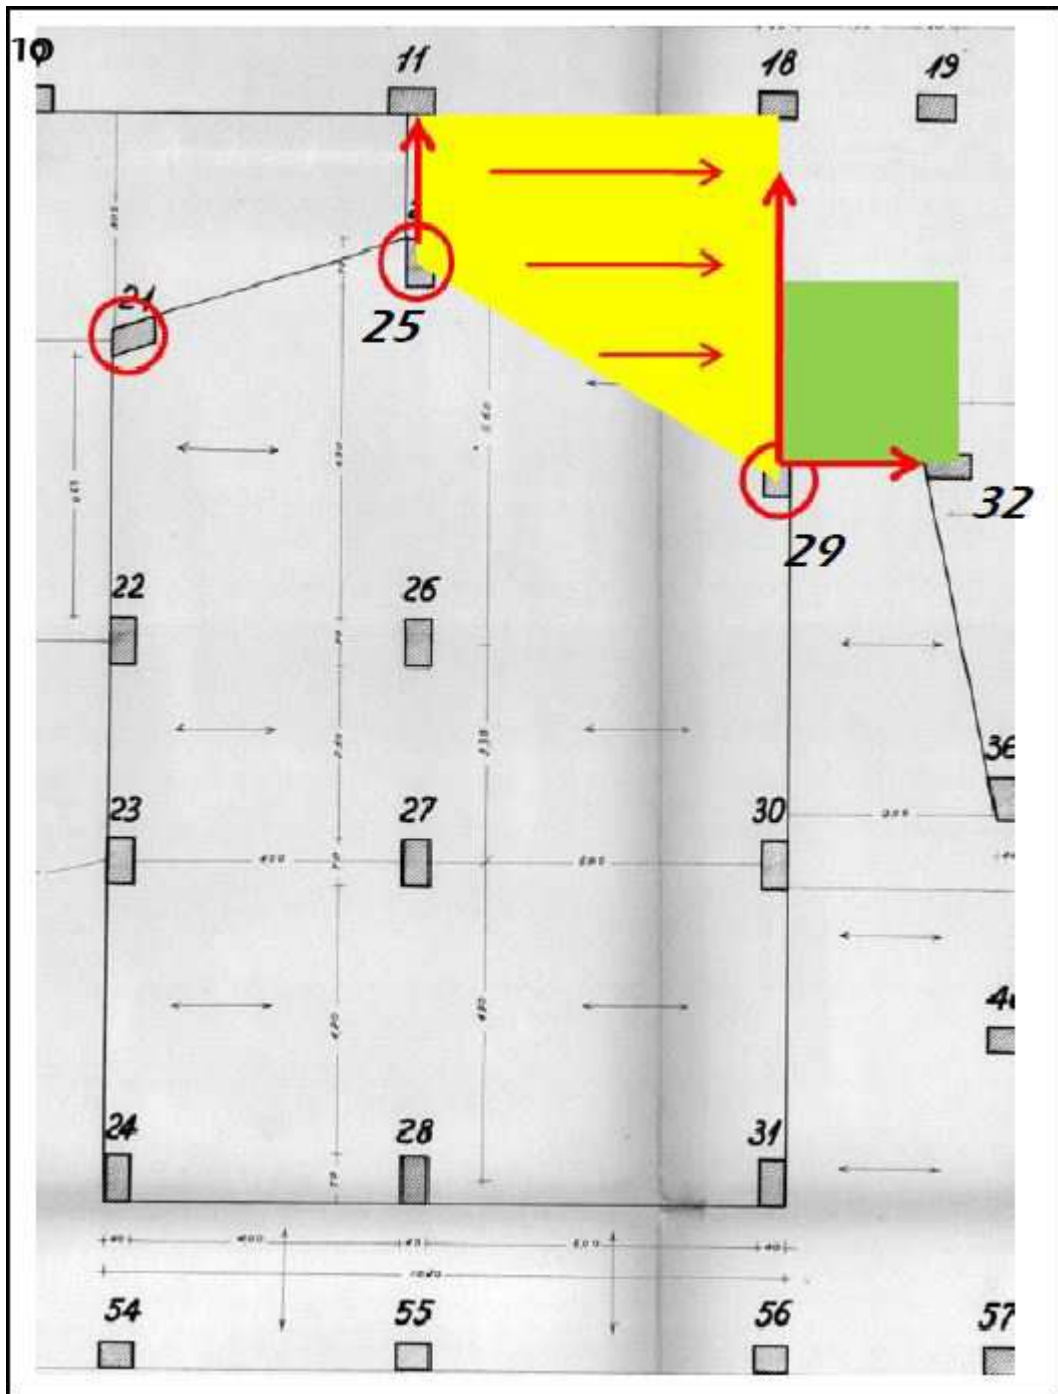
Effetti sulla pianta strutturale della Casa dello Studente. In giallo è indicata l'area fortemente interessata tra le travi 11-25 e 18-29
